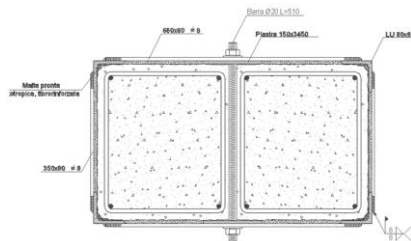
Dettaglio solidarizzazione pilastri centrali
